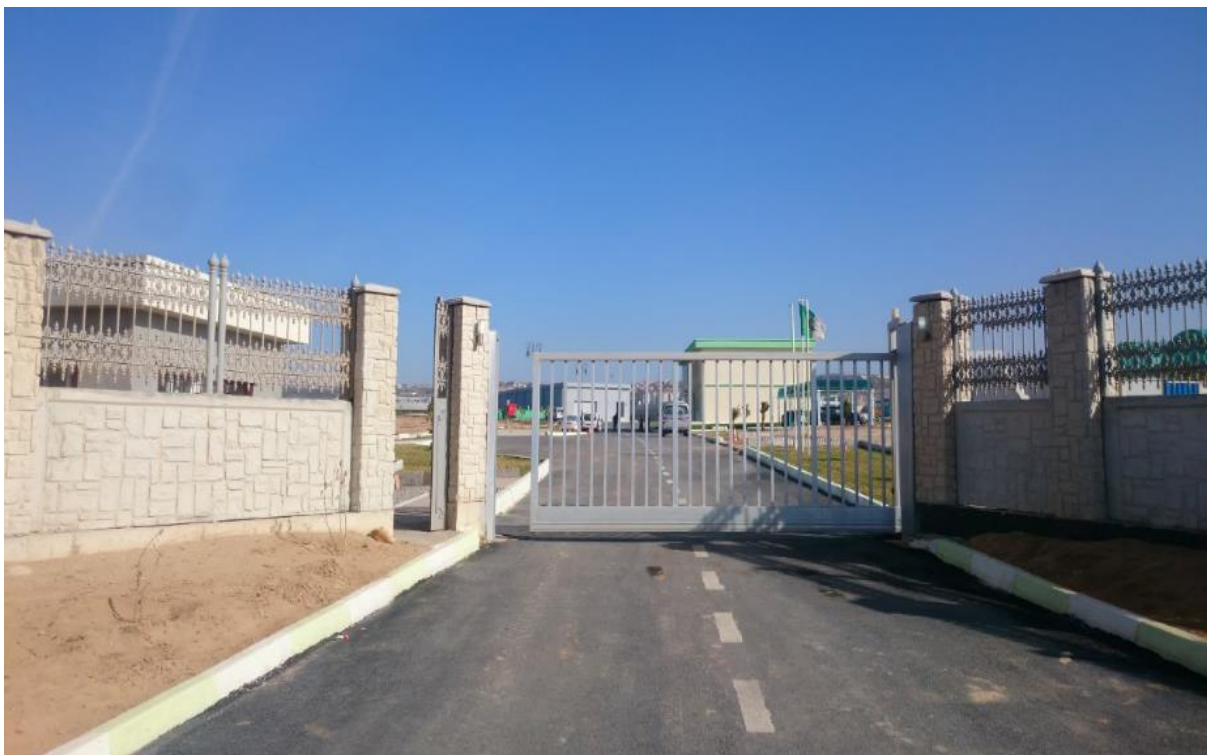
Photo de constat, l'entrée de la station d'épuration, auteur 30/01/2017.
